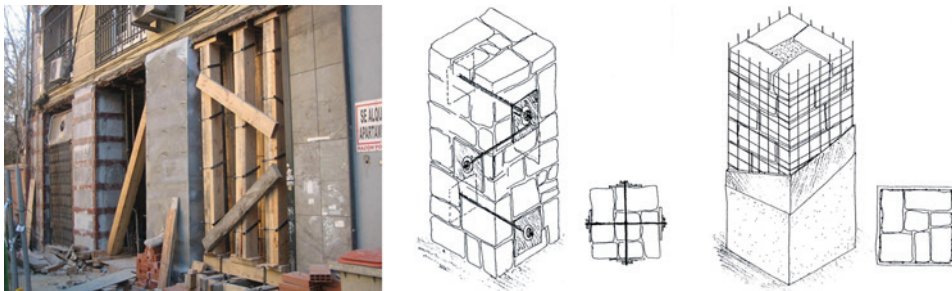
En la foto, refuerzo de pilar de ladrillo mediante zunchado con angulares y presillas metálicas. En el gráfico del centro, refuerzo de pilar de piedra mediante tirantes metálicos distribuidos de forma alternada en altura. En el gráfico de la derecha, refuerzo de pilar de piedra (podría ser también de ladrillo) mediante recrecido de hormigón armado.
